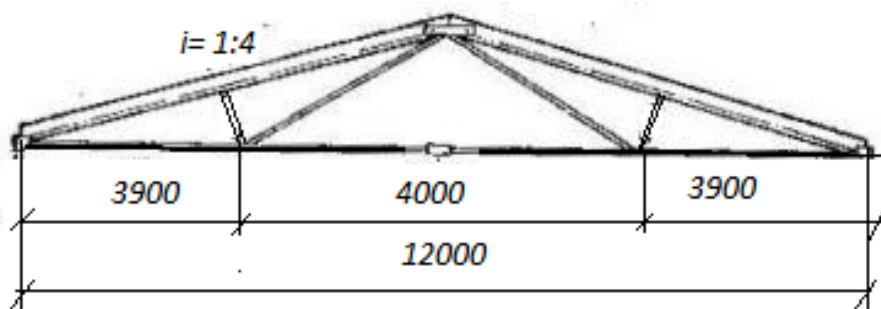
Треугольная ферма пролетом 12 м с брусчатым верхним поясом
